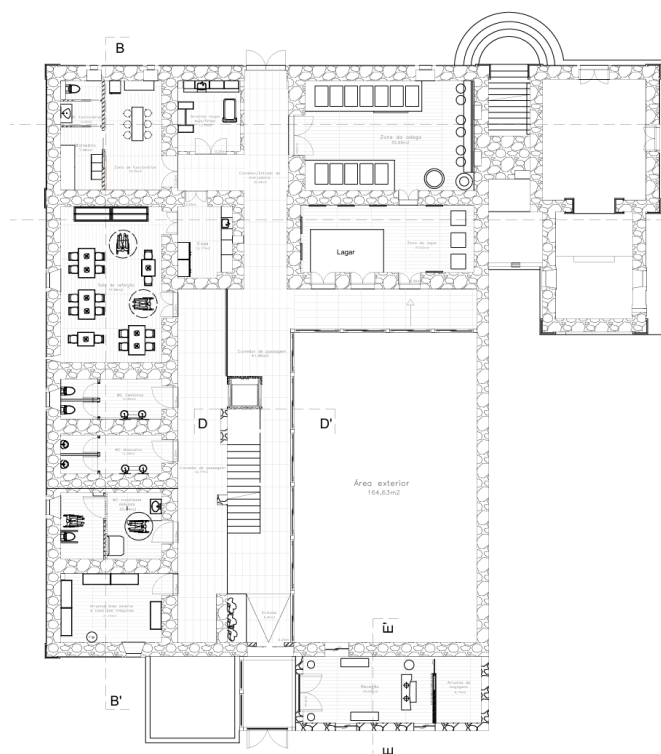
Planta de apresentação do piso 0, Fonte: Autor
